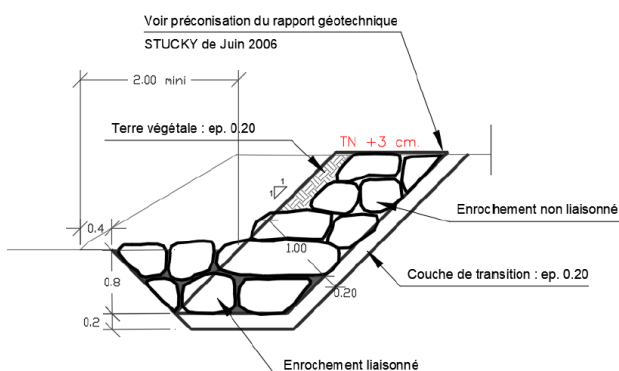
Extrait du plan projet de la protection de berge rive gauche (ABEST, 2008)
